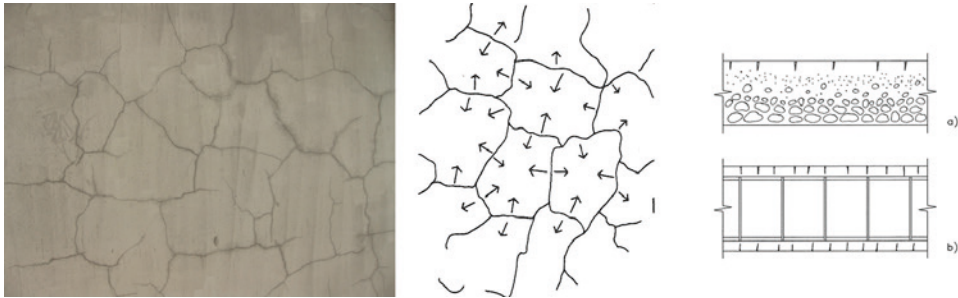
En la foto izquierda, detalle del trazado típico de las grietas de afogado. En el gráfico central, representación de las tensiones de retracción causantes de las grietas. En el gráfico superior de la derecha, solera de hormigón con grietas de afogado debido a la acumulación de árido fino en la parte superior por exceso de vibrado; en el gráfico inferior, nervio de hormigón armado con grietas de afogado en el recubrimiento de la pieza, inducidas por el efecto rigidizador de la armadura sobre el núcleo interior.
